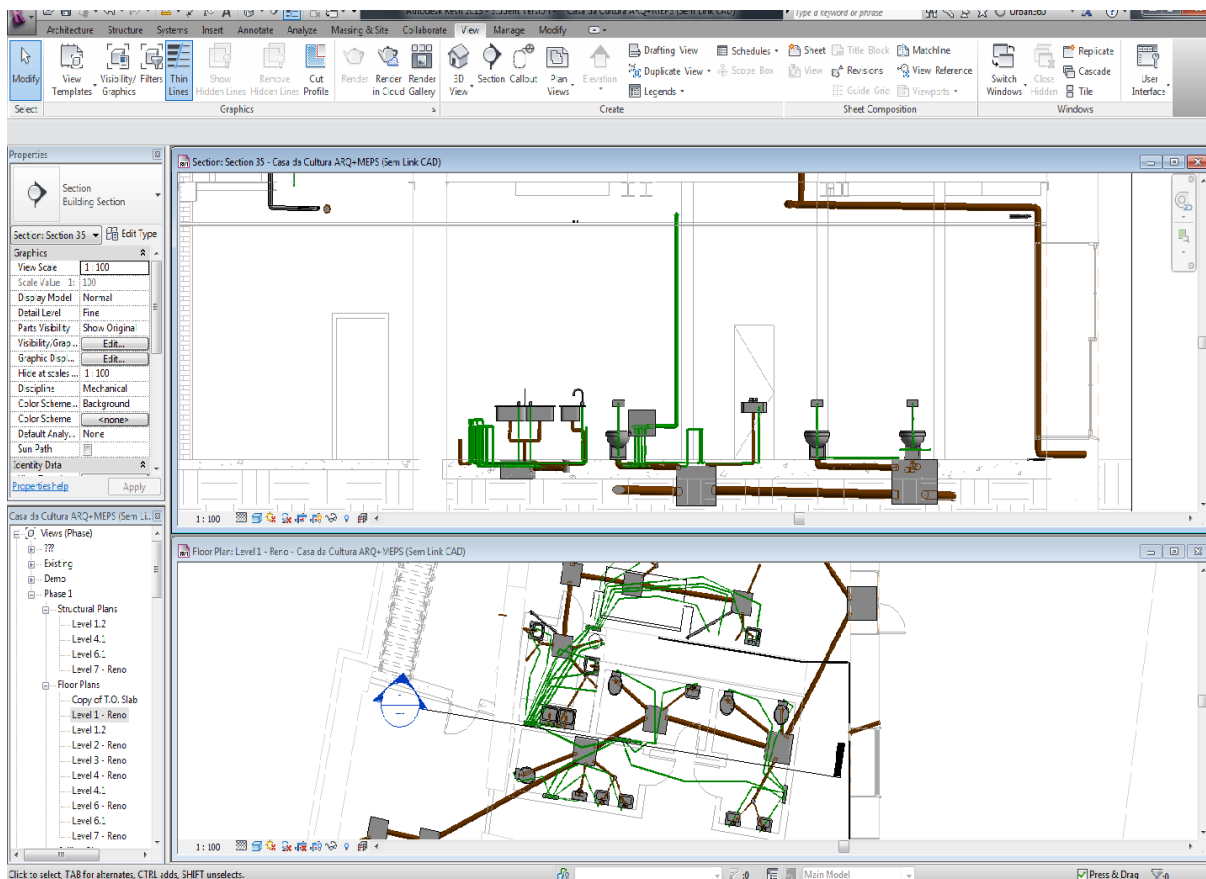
Abaixo – Linha de corte em planta. Cima – Vista automática gerada.
